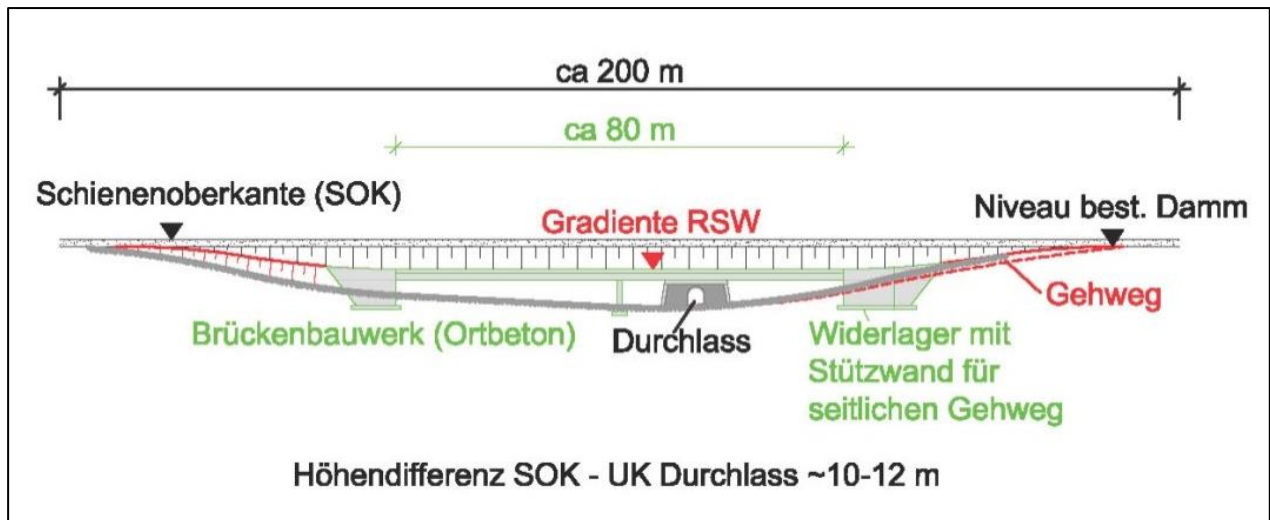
Bauwerksskizze BW 06 „Heggen“ (Abmessungen grob geschätzt); Balkentragwerk als 2-Feld-Träger - Konstanter Querschnitt / angevoutet
